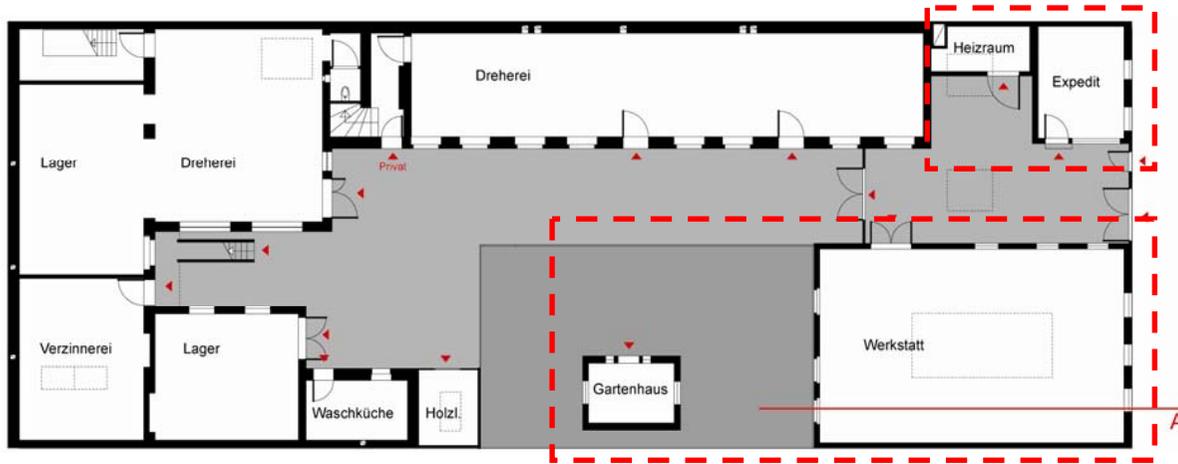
Grundriss Erdgeschoss, neue Werkstatt an der Gusenleithnergasse, und dem Gartenhaus im Hof
